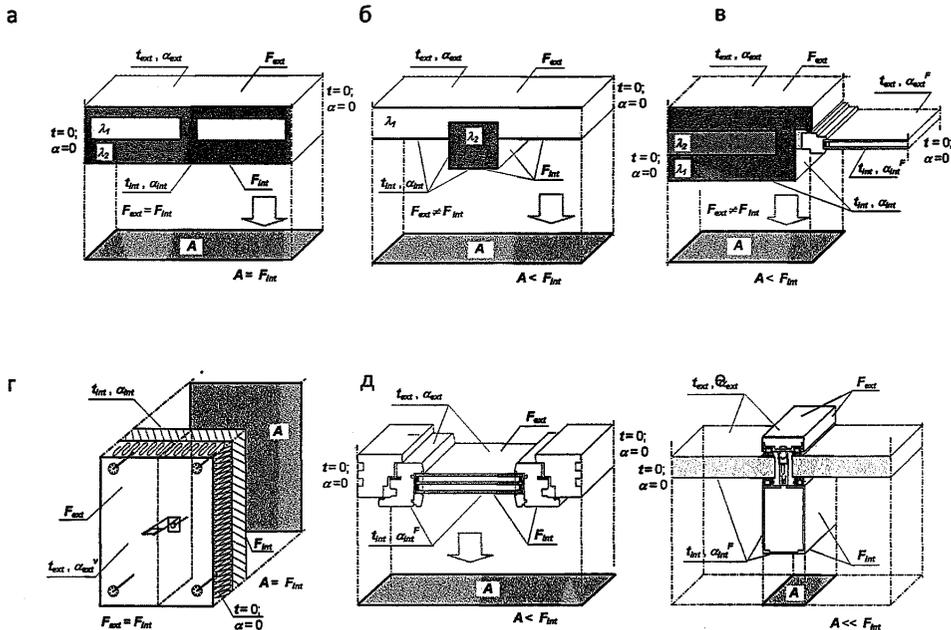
Примеры задания граничных условий и определения площадей приведения A_i для расчета приведенного сопротивления теплопередаче некоторых конструкций: а, б – фрагмента наружной стены с теплопроводными включениями без проемов; в – фрагмента наружной стены с оконным блоком; г – фрагмента наружной стены с фасадной изоляцией; д – оконного блока; е – системы профилей
